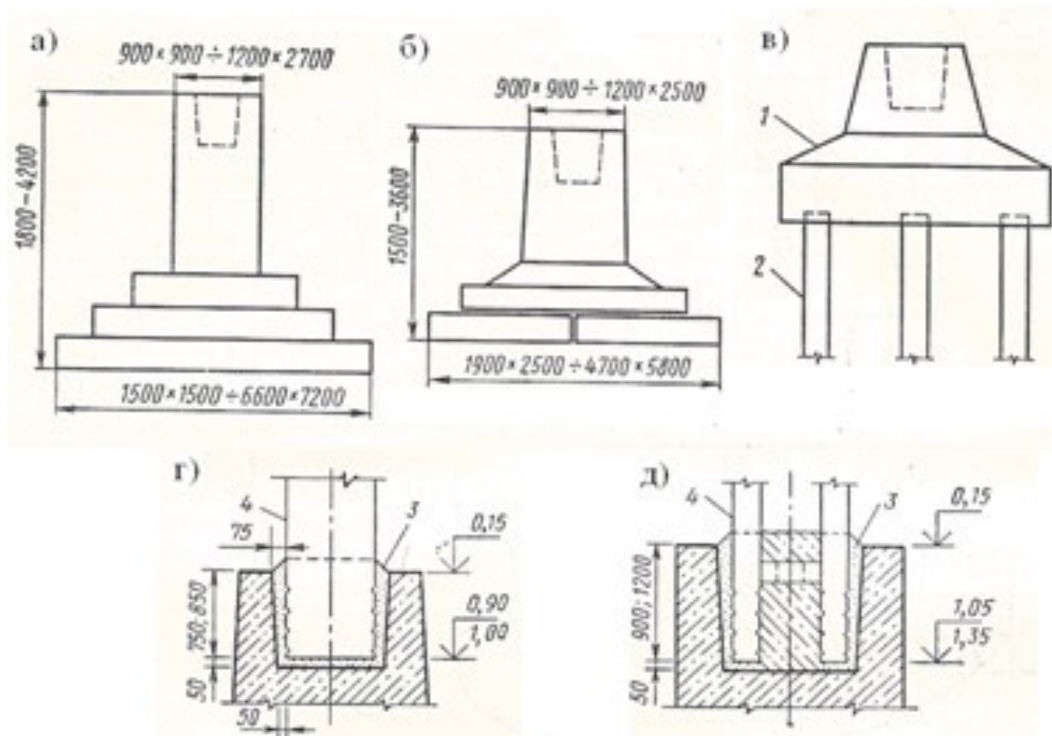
Отдельно стоящие фундаменты и способы заделки в них колонн а) монолитный; б) сборный; в) свайный; г, д) заделка колонн в фундаменты; 1- ростверк; 2- свая; 3- бетон; 4- колонна
